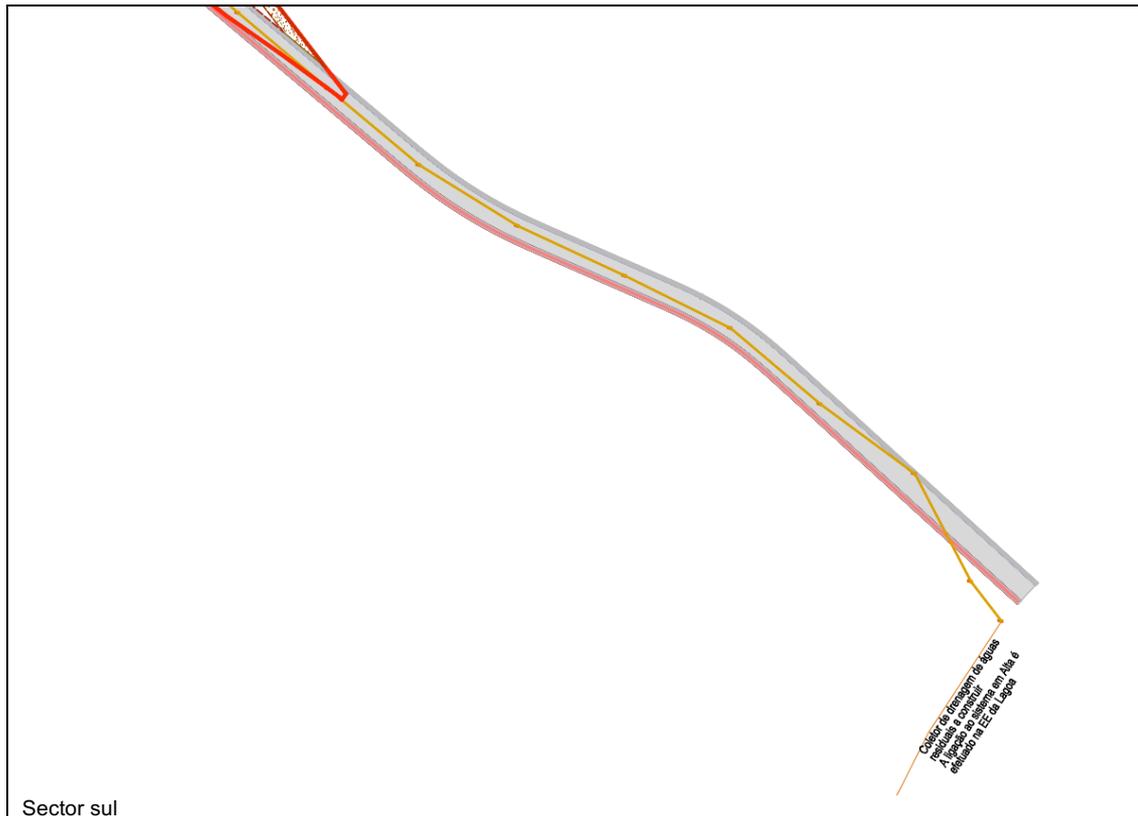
Detalhe com ligações à rede de saneamento existente.
